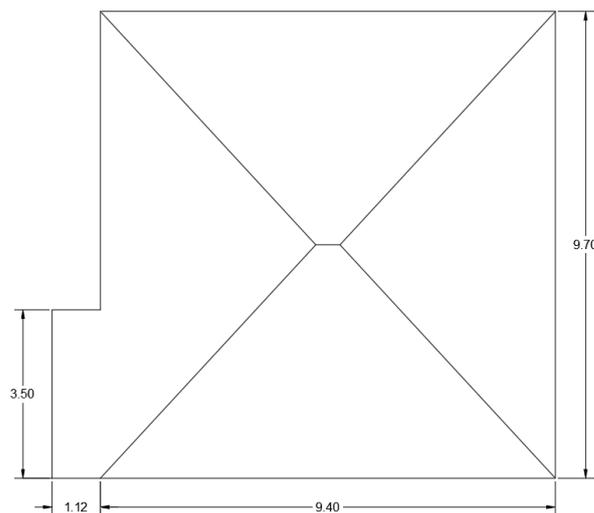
Dimensiones de la cubierta (Fuente propia).
